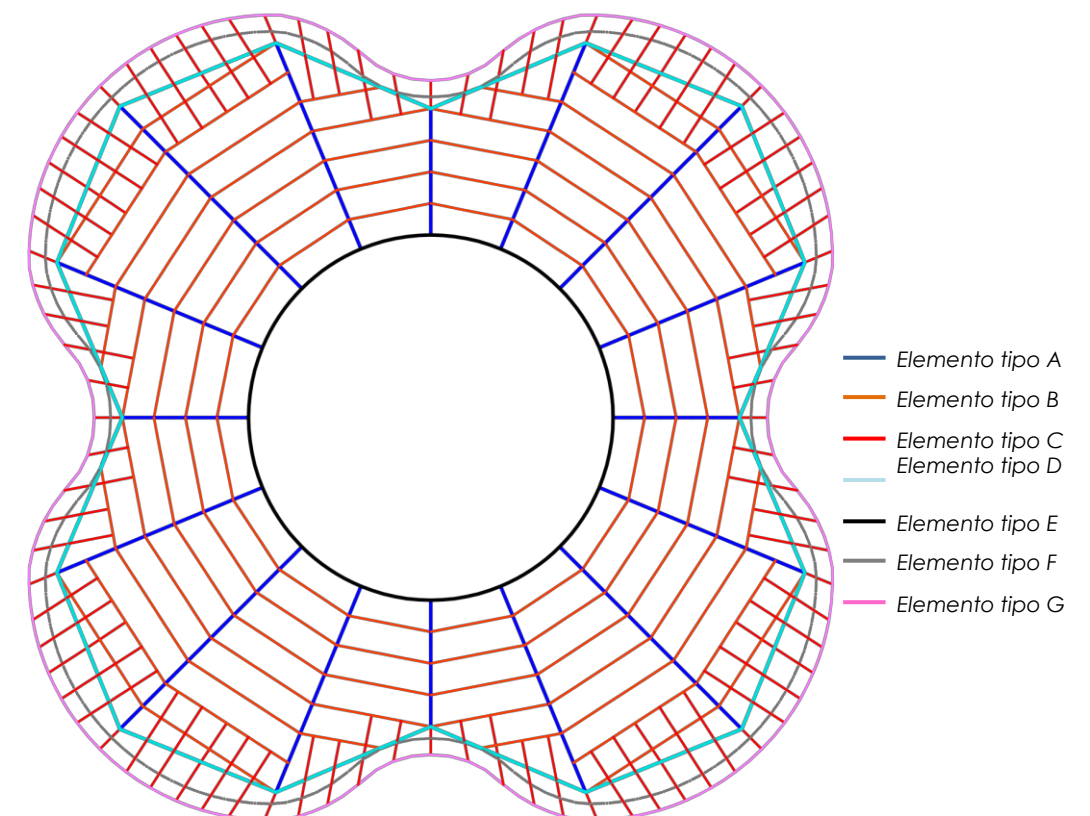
Modelización inicial estructural de la planta tipo 1
